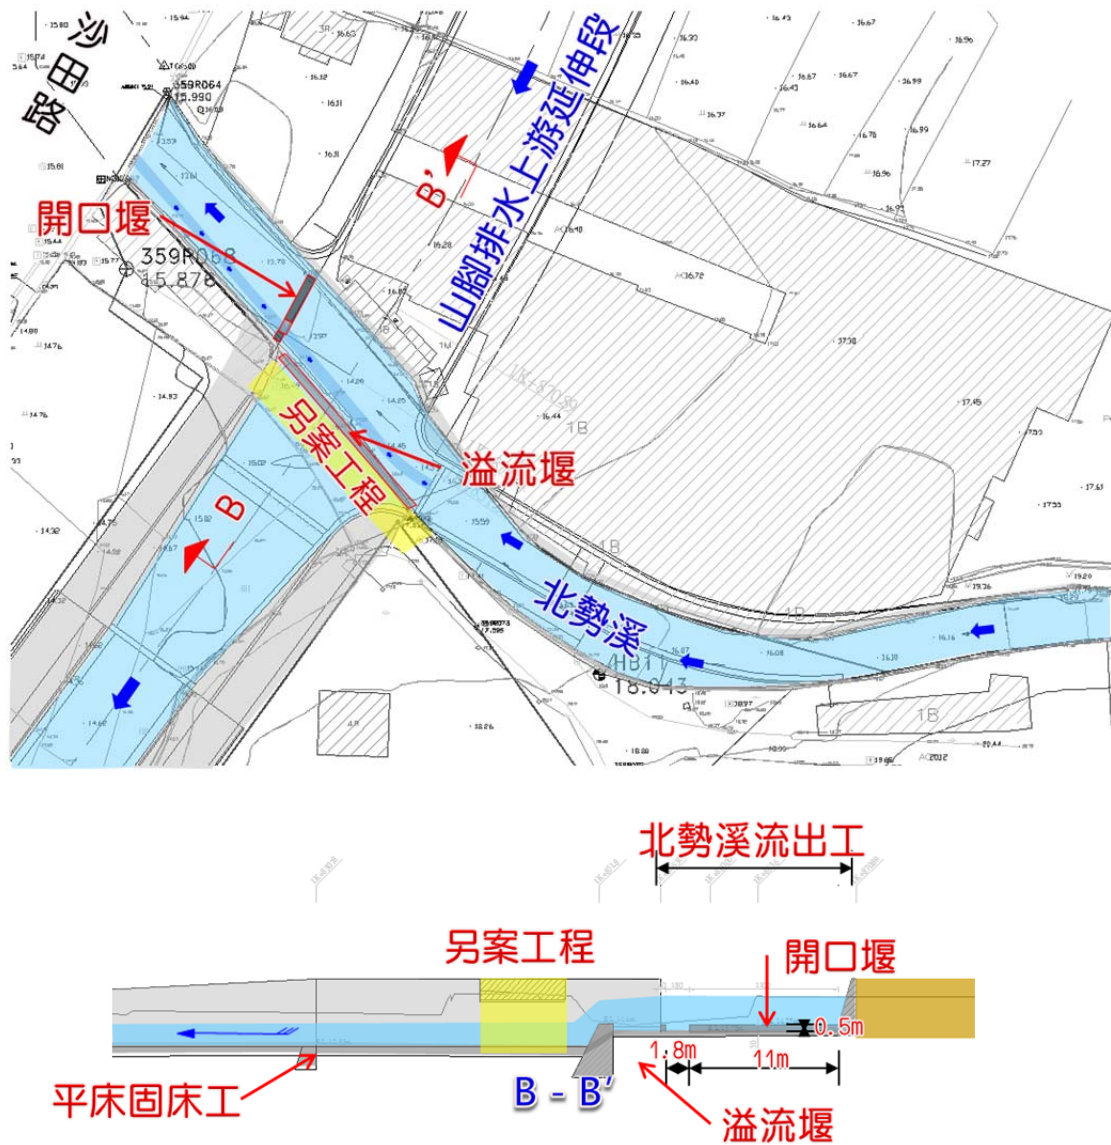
北勢溪未改善前施工規劃平面及剖面圖(一)
